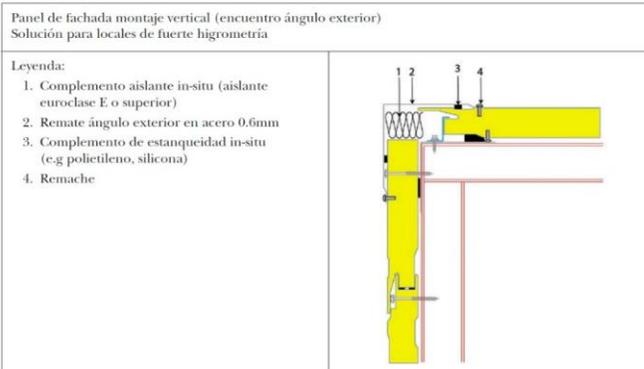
(2) Ejemplos de soluciones constructivas para locales con fuerte higrometría. Fuente: RAGE
